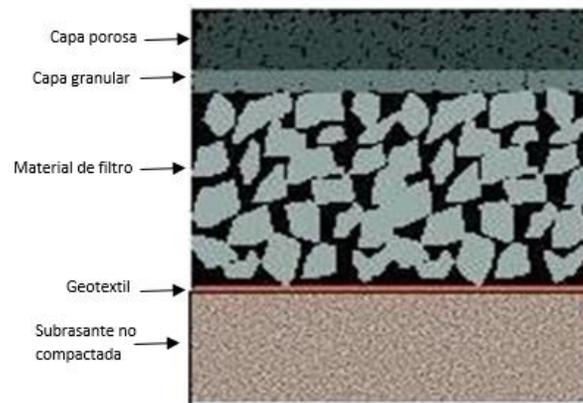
Estructura de pavimento poroso recomendado por la NAPA
